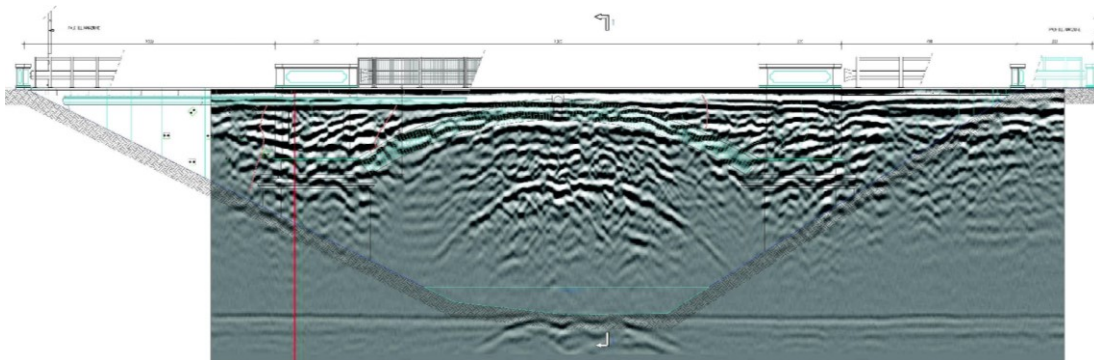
e. Prospetto con sovrapposizione profilo georadar
